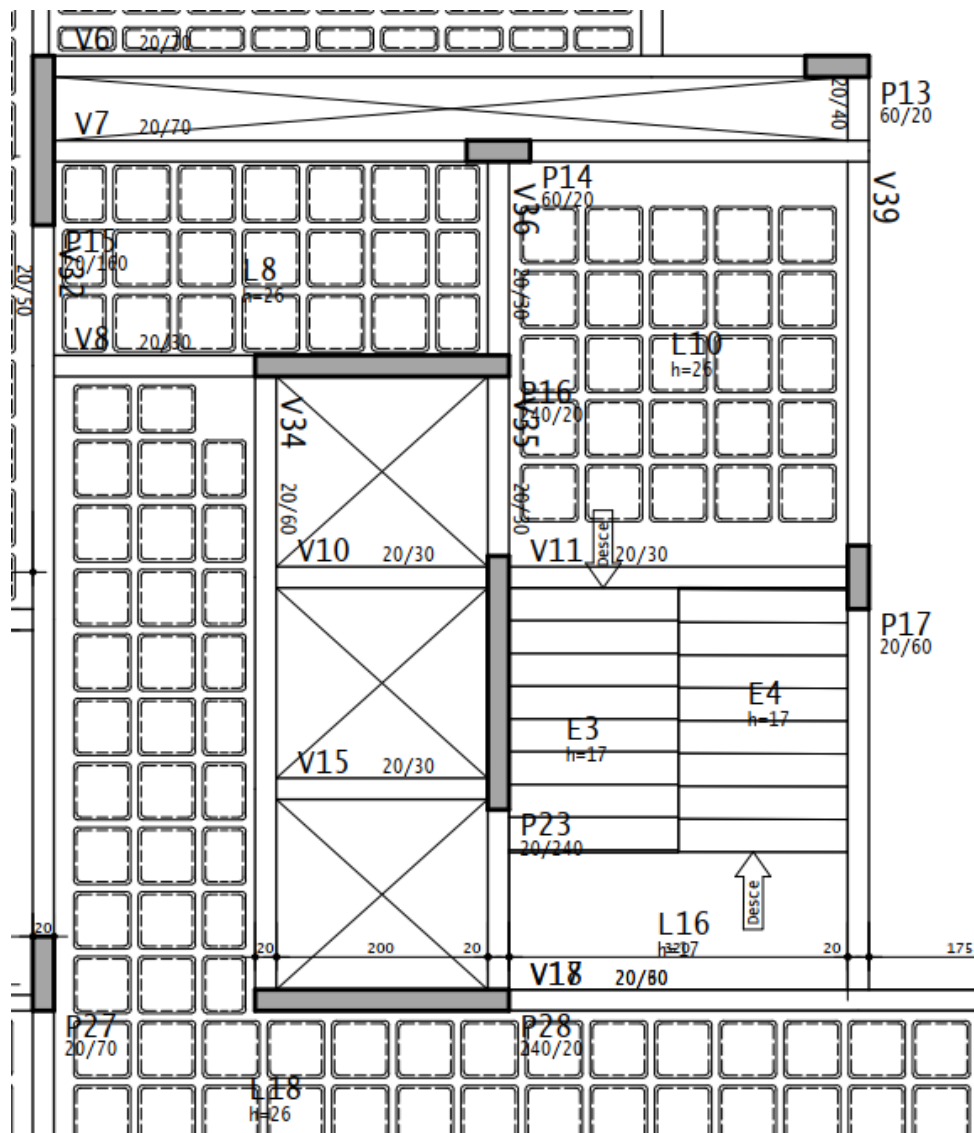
Planta de Fôrmas e Interferência Arquitetura concepção 2.
